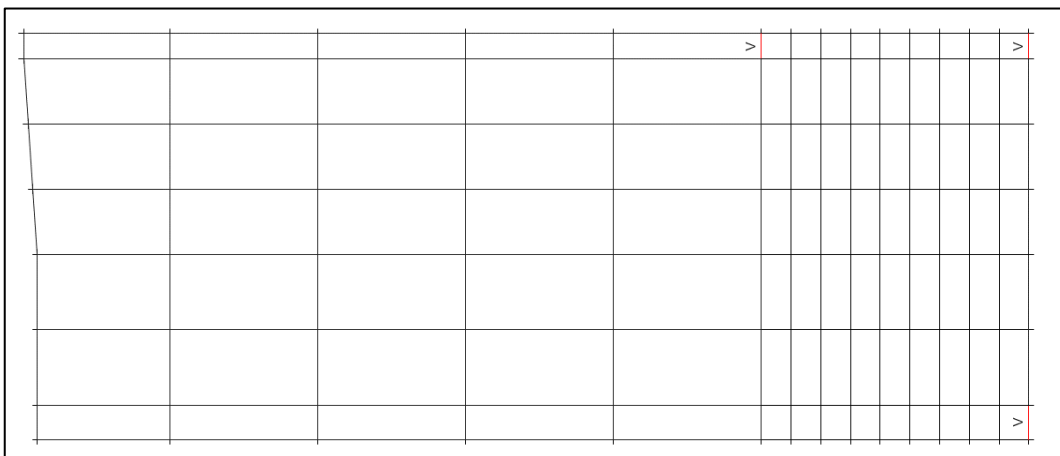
Falla en vigas de hormigón – Bloque 2. Cubierta (Castillo & Peñaloza, 2022)
